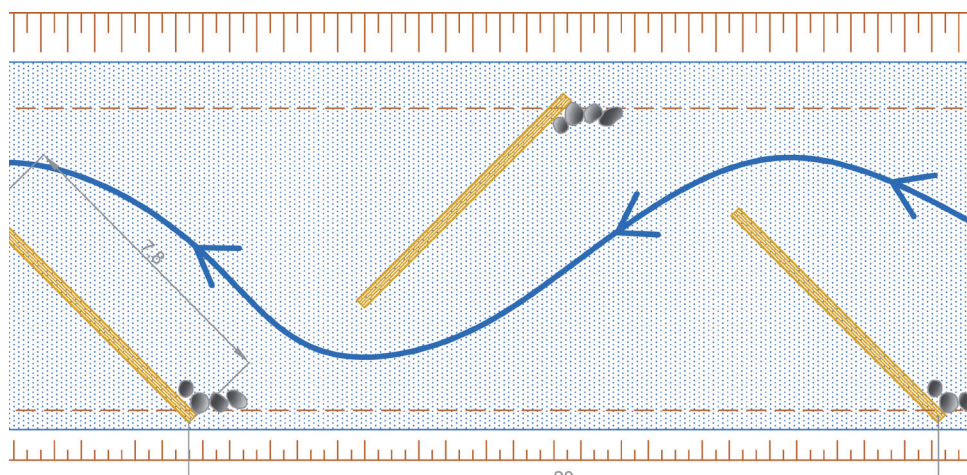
SCHEMA PLANIMETRICO DI UN INTERVENTO TIPO
